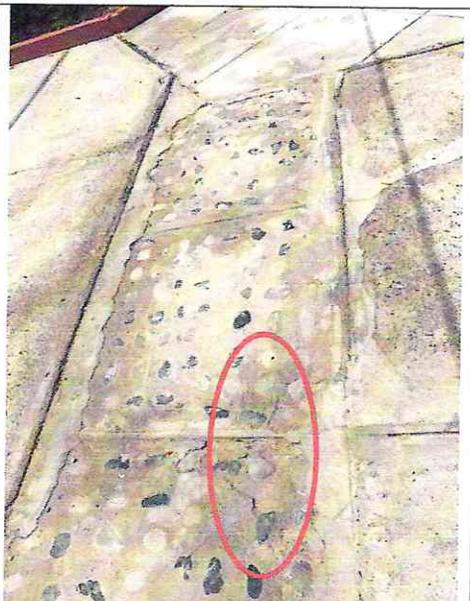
Veredas de concreto con grietas y desgaste en su superficie.
